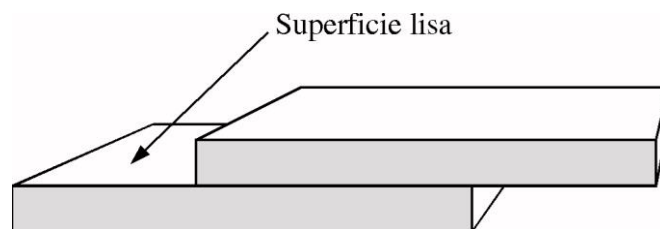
Tipo de apoyo de deslizamiento en acero
